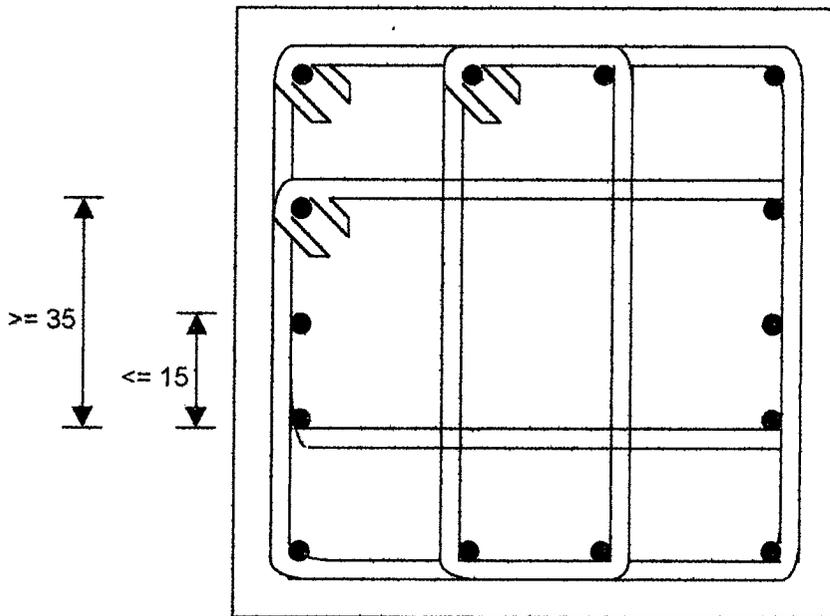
c Distribución admisible de estribos y barras longitudinales en columnas.
